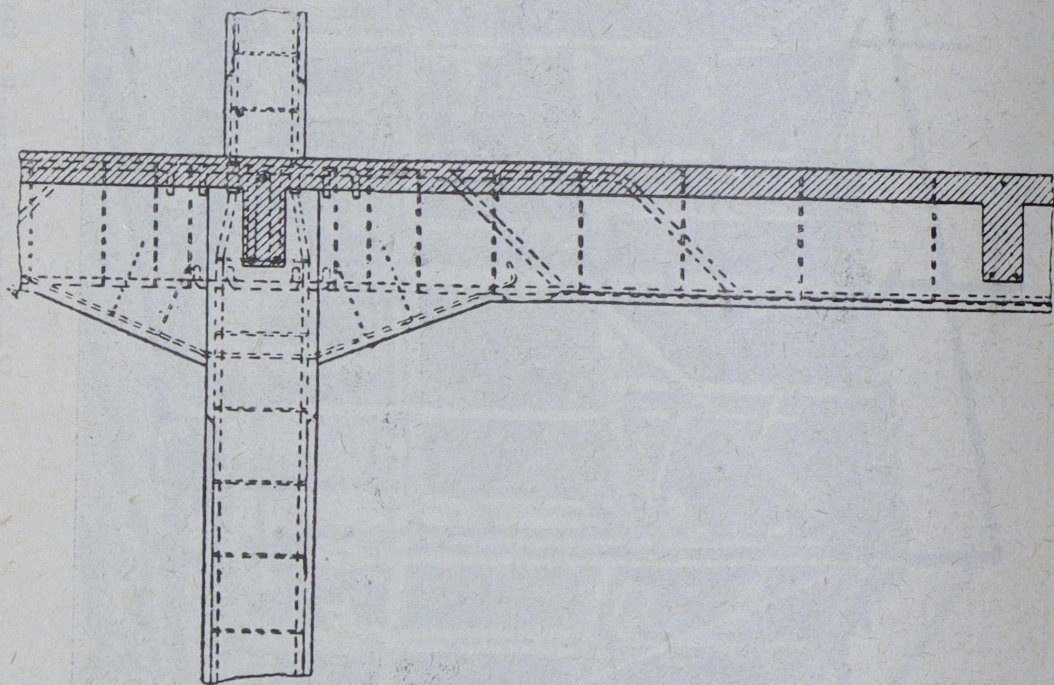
Военное депо Клостернейбурга. Соединеніе главныхъ балокъ со столбами.
